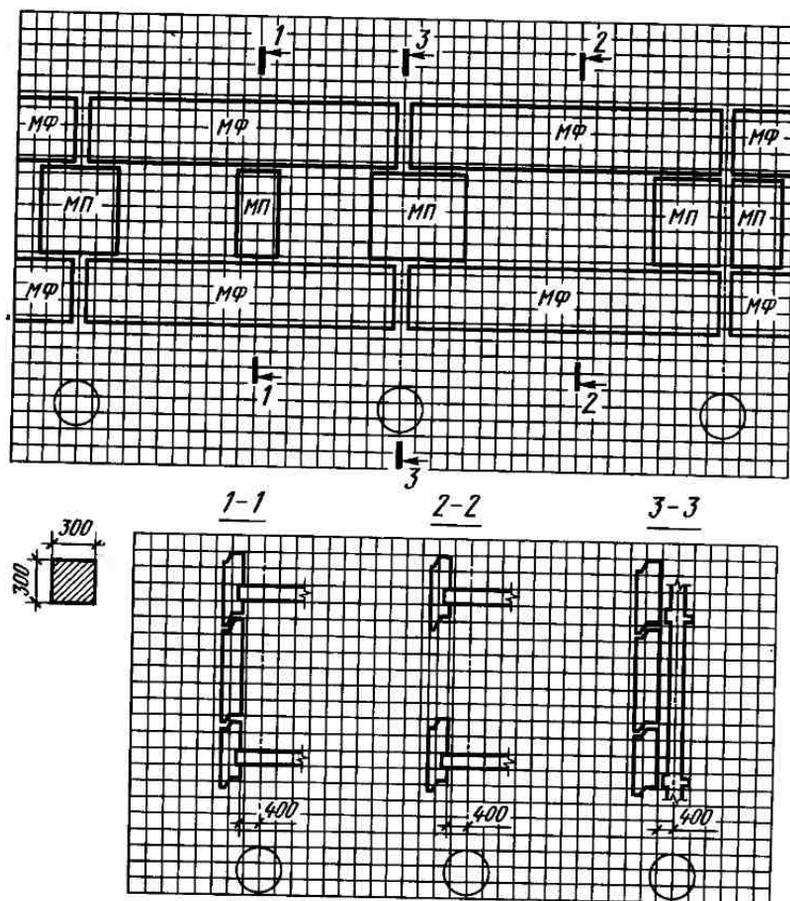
Фрагмент фасада каркасно-панельного здания:
